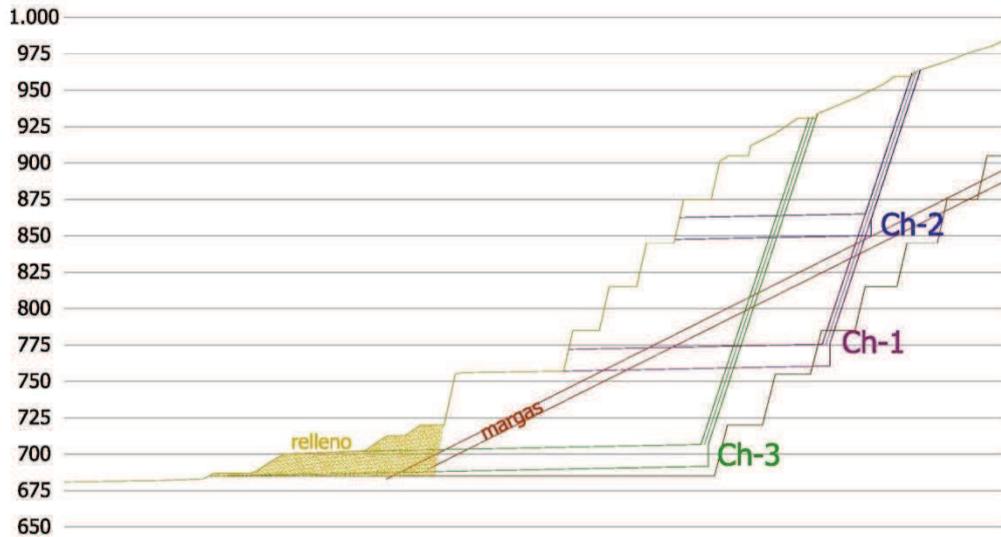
Perfiles de las alternativas de transporte por chimenea-galería
